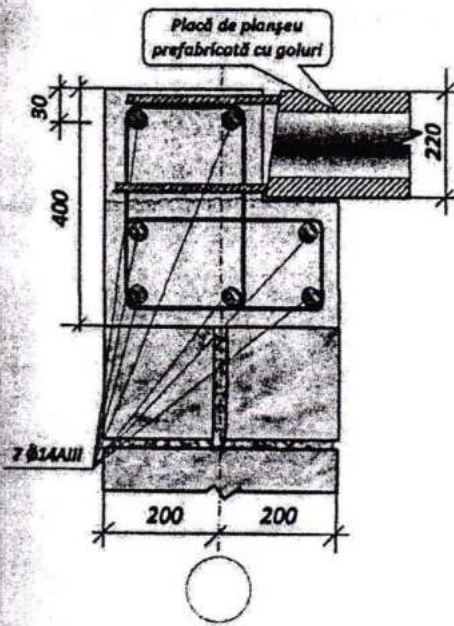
Scheme constructive a fundației continue, pereților structurali și planșeului
